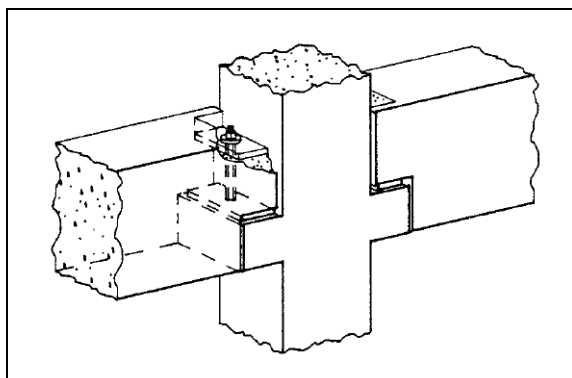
Ligação por consola curta de betão com ferrolho (Sidney, 2000)
